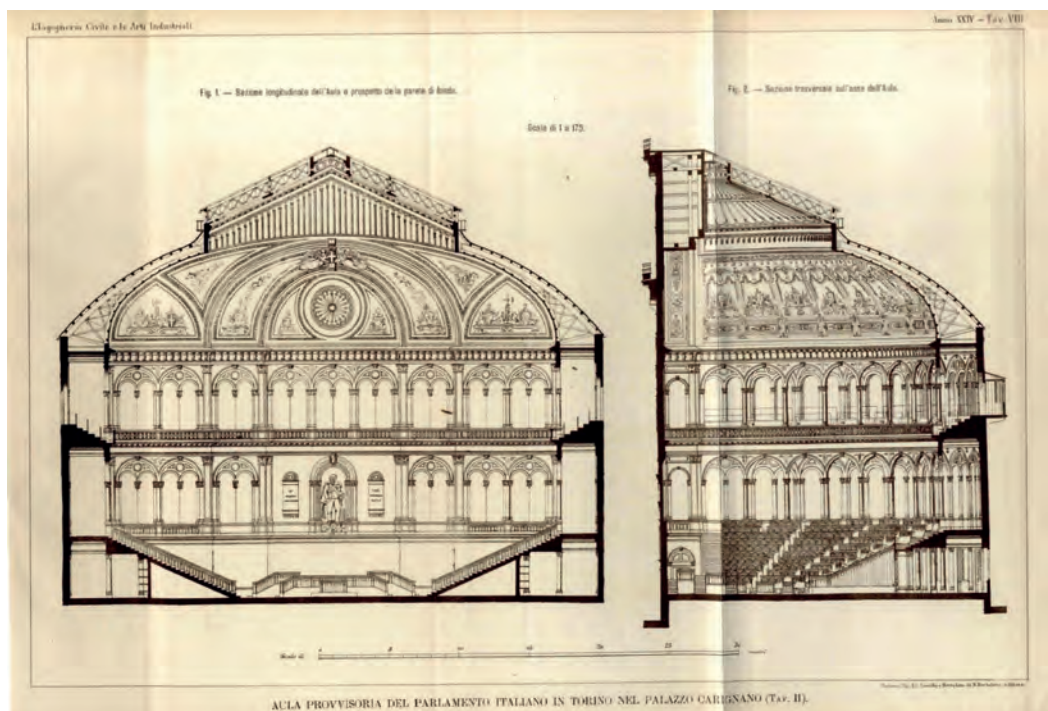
Sezione longitudinale e trasversale dell'aula provvisoria. Fonte: Pulciano 1898, Tav. II.
